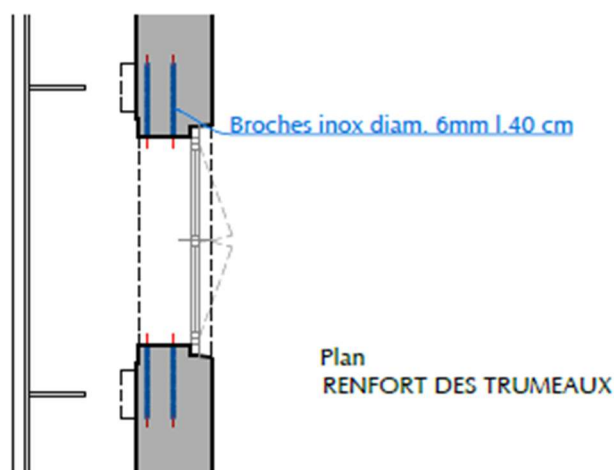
Elévation d'un balcon, mise en évidence du renforcement des trumeaux.
